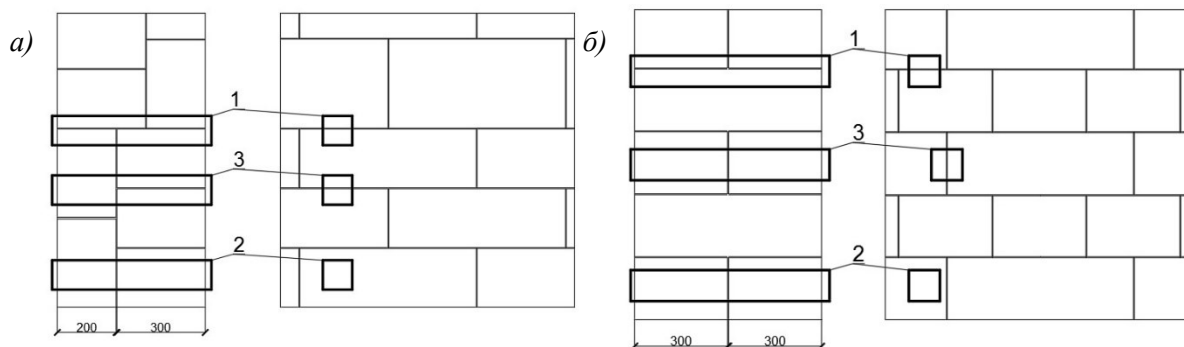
Поперечный разрез и общий вид фрагментов кладок из газобетонных блоков для определения приведенного сопротивления теплопередаче: *а* – энергоэффективная кладка;
